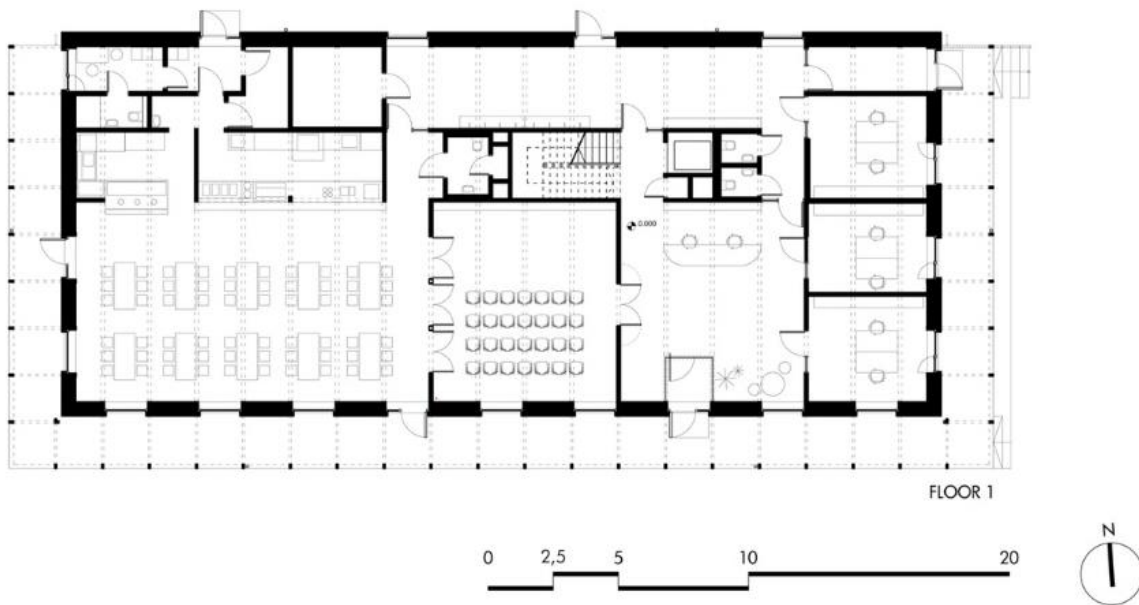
AVOTI Timber Office Building in Lizums План 1го поверху[17]
